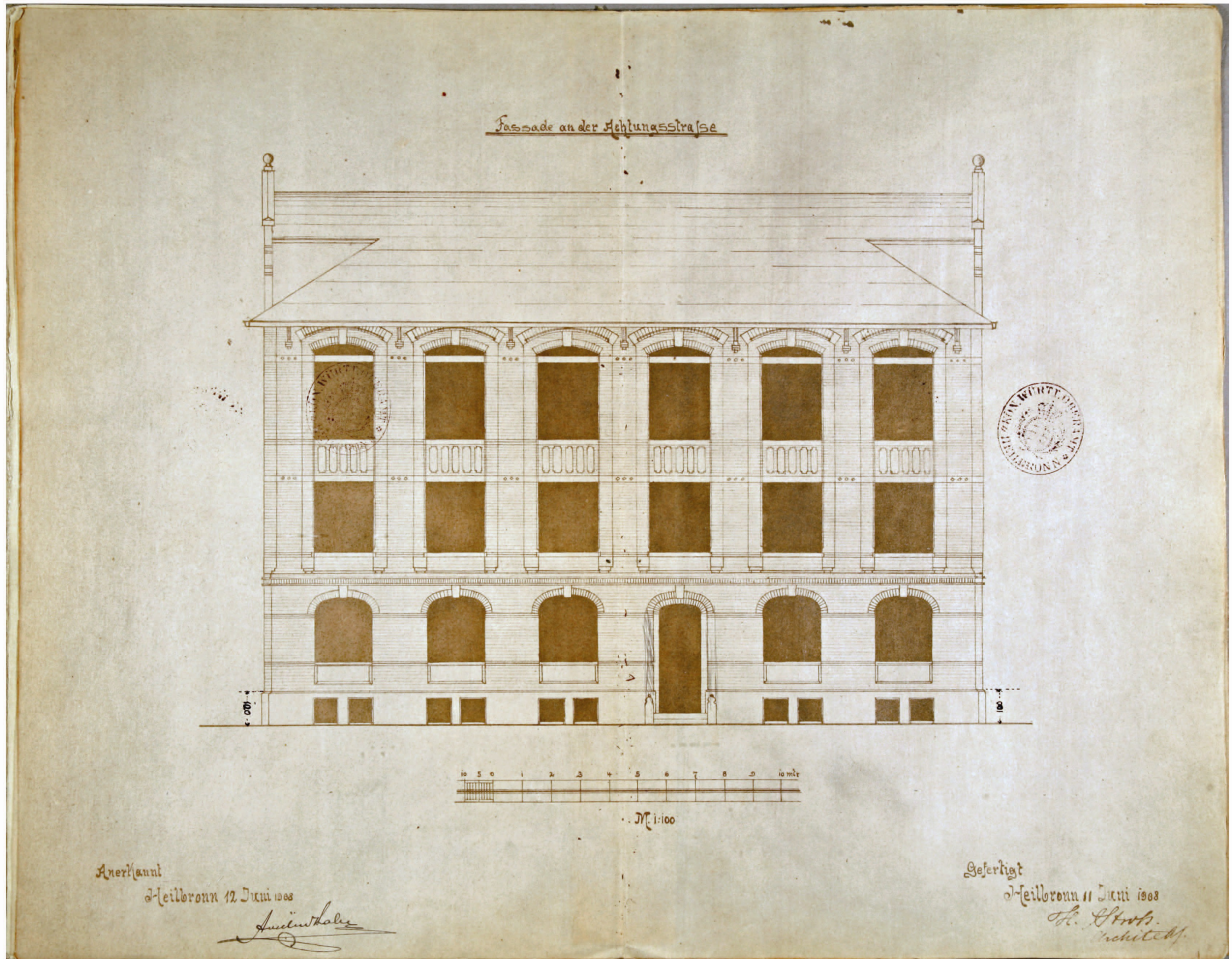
Gebäudeansicht zur Achtungstraße, Plan 1908. Foto: Stadtarchiv Heilbronn.
